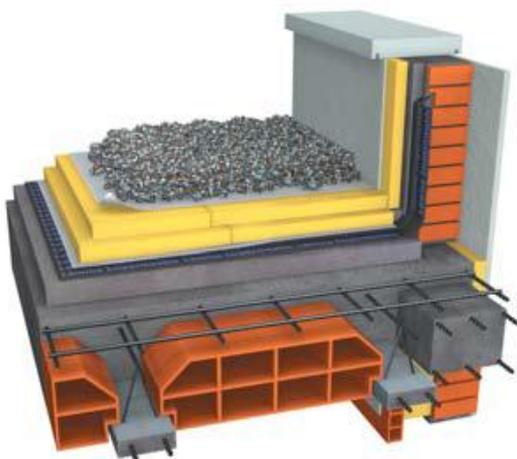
Rehabilitación de cubierta plana invertida (Fuente: Ursa)
